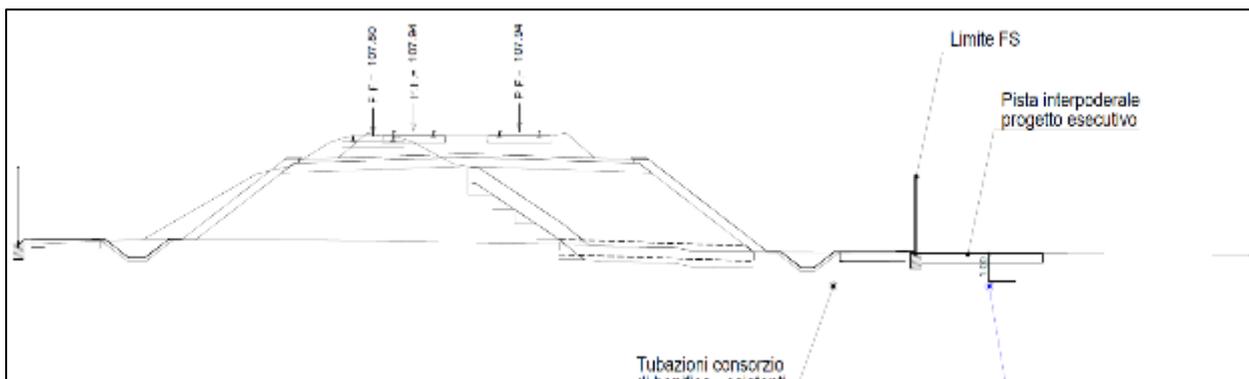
Spostamento tubazione - Sezione tipo tubazione terziaria
